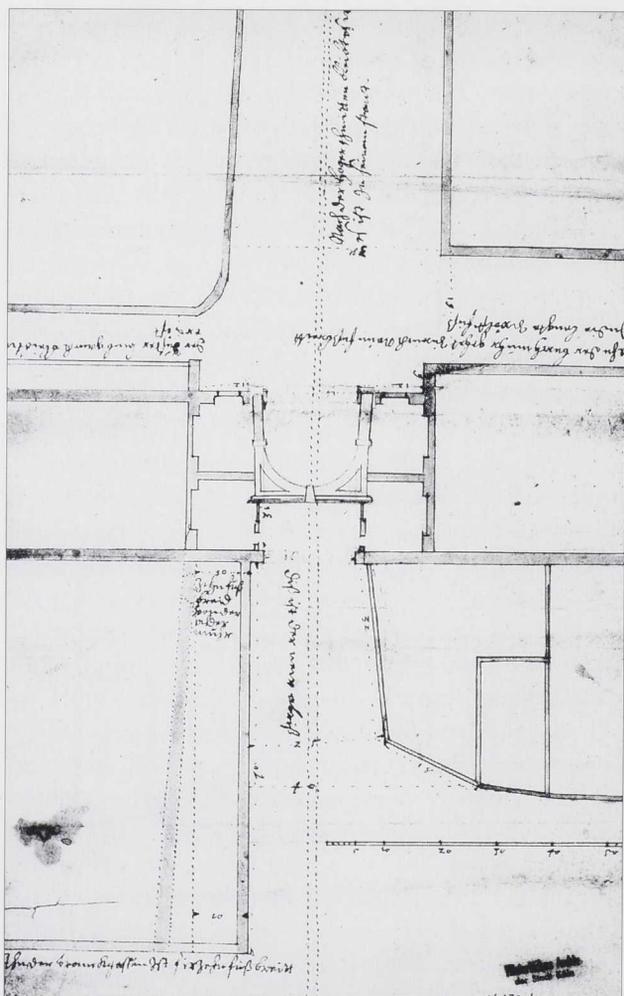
Plan zur geplanten Begradigung der Straße »Unter Fettehennen« (1823). Köln, Historisches Archiv.
